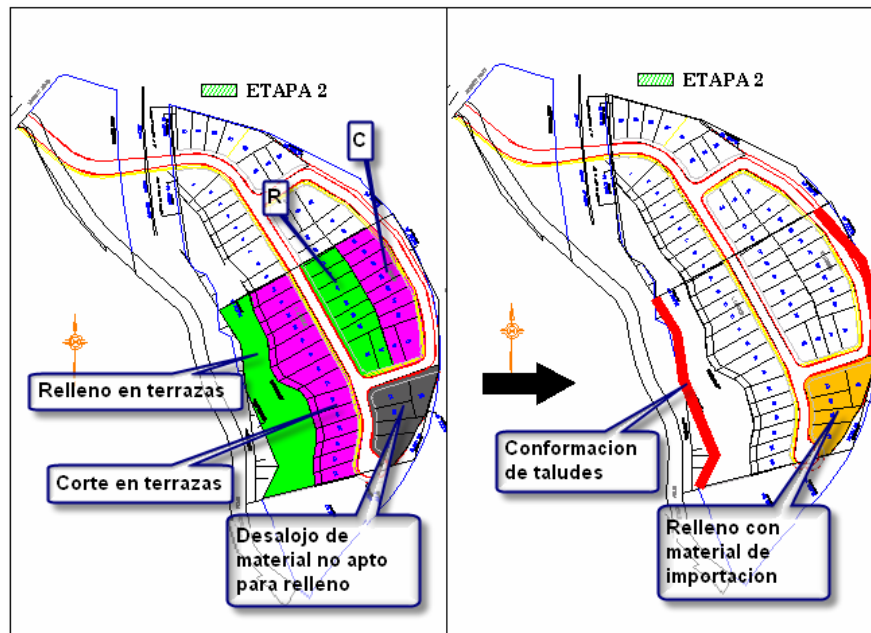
Ejemplo de esquematización en planta de fases para desarrollar el corte en terrazas, rellenos en terrazas y perfilado de taludes, para una segunda etapa de construcción.
